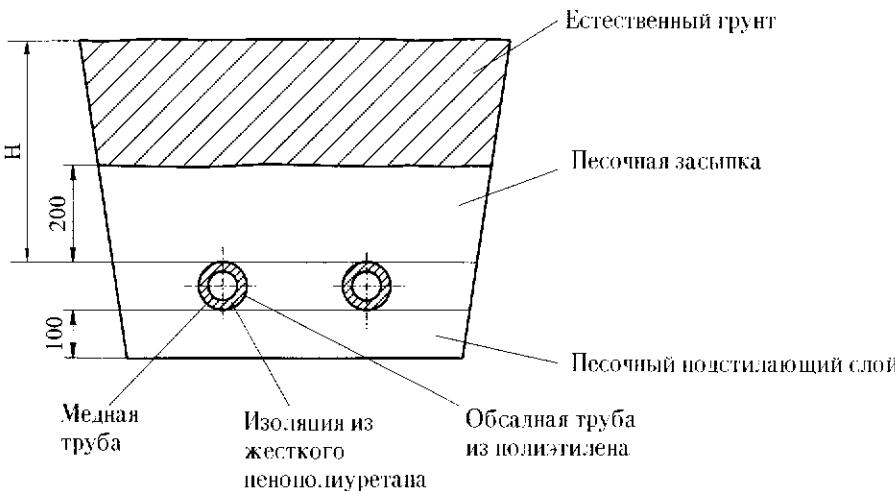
Бесканальный трубопровод, выполненный из предварительно изолированных труб
